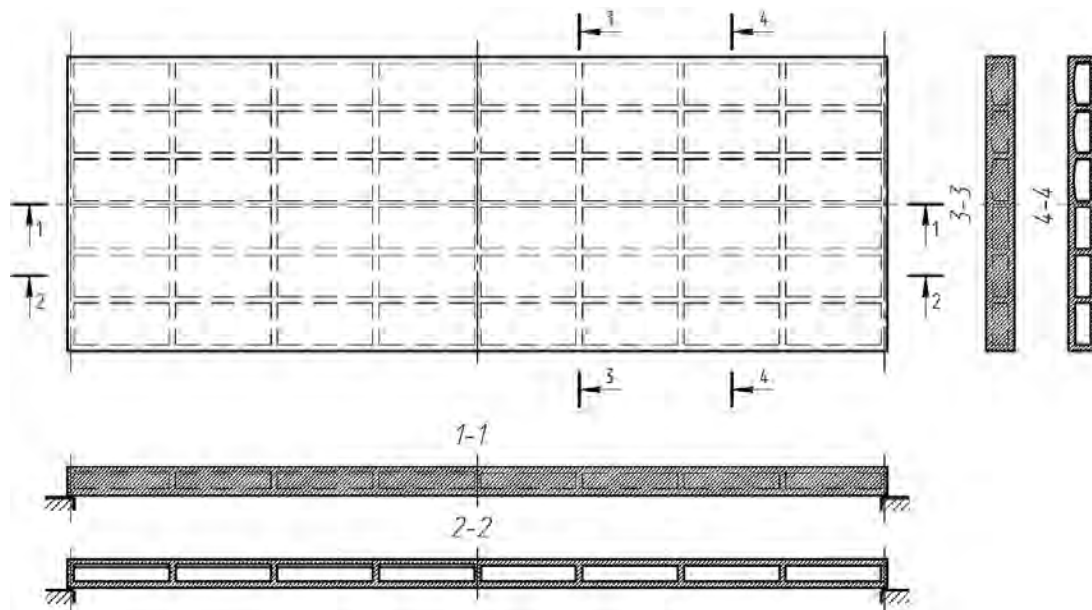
Монолітна залізобетонна плоска прогонова будова з внутрішніми поздовжніми та поперечними балками
